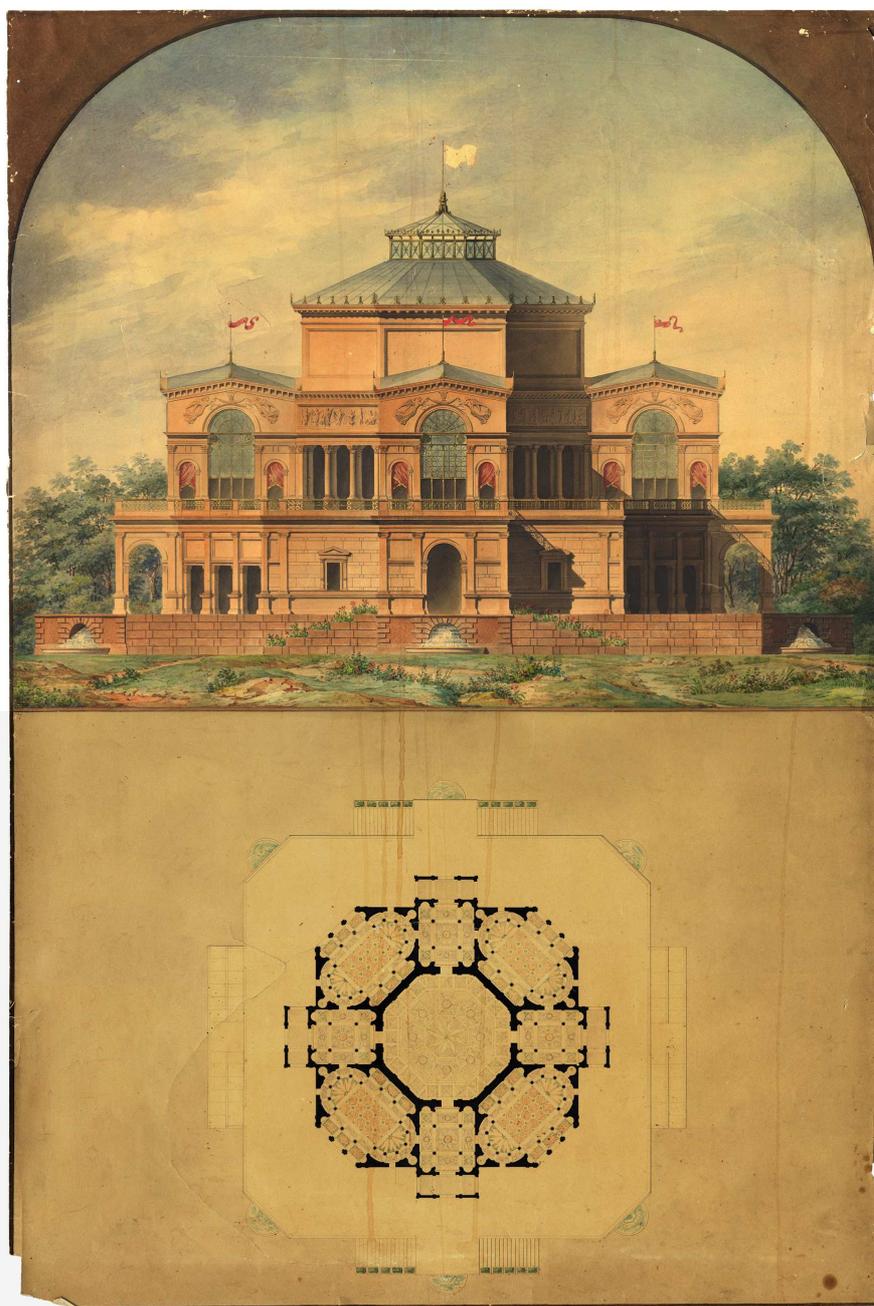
Pianta e prospetto raffigurati nella tavola originale.
